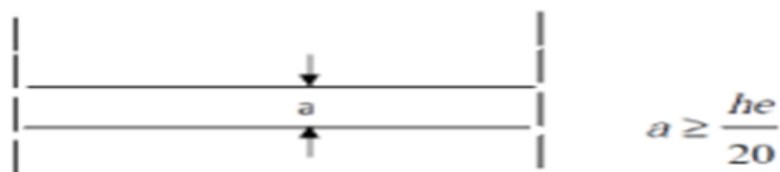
Coupe verticale des types des voiles en plan (RPA 99 /version 2003)
